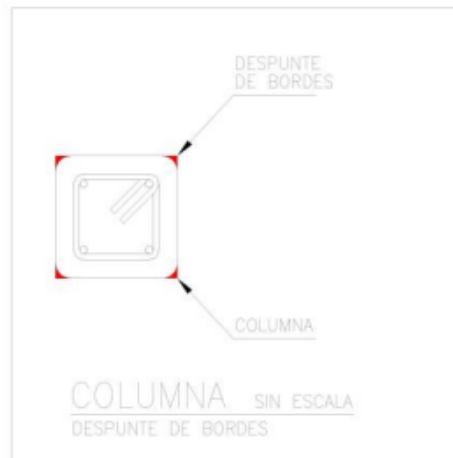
Primer paso despuntar los bordes de la columna de concreto.
